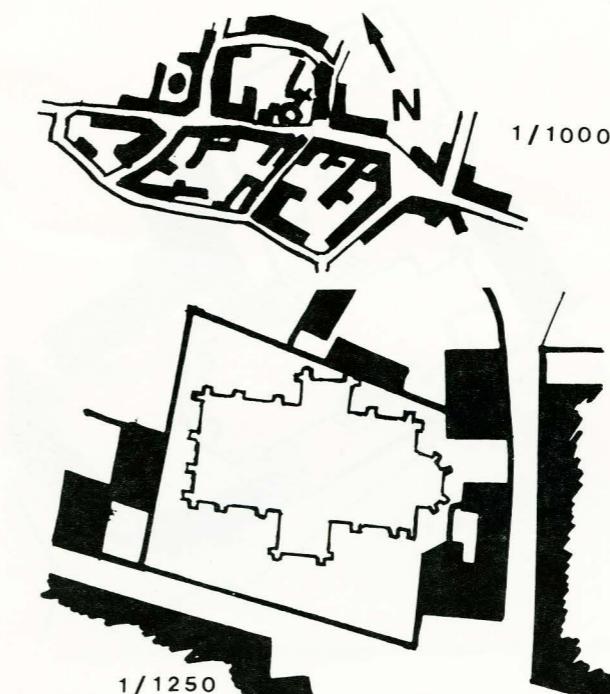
plans de masse et de l'église de Baron, 1812.
